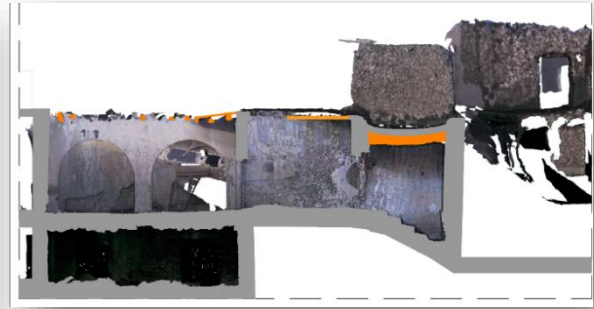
Photo texturée 3d de la coupe B.B indiquant un affaissement de la toiture causé par un tassement différentiel des fondations en plus d'une surcharge de structure. Source : Auteure.2022.
